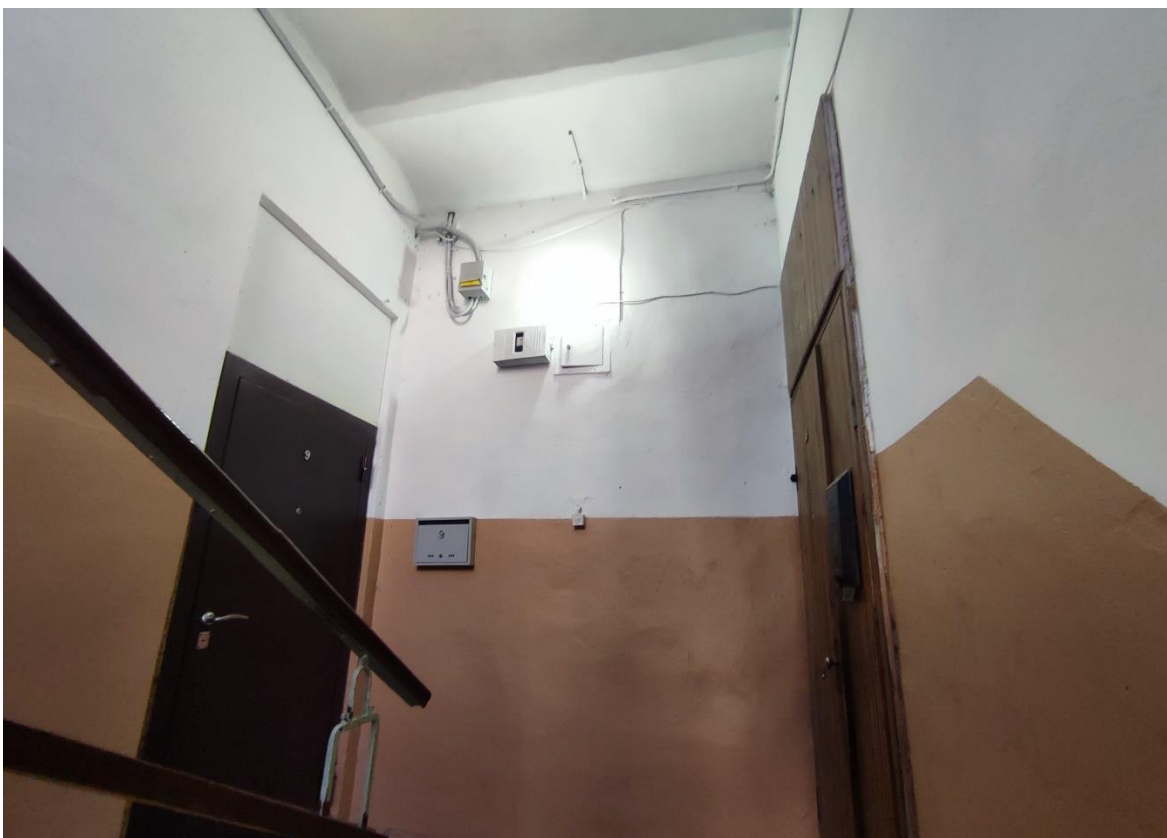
1-ый этаж лестничной клетки ЛК-3. Расположение электропроводки по стенам с нарушением способа прокладки.
